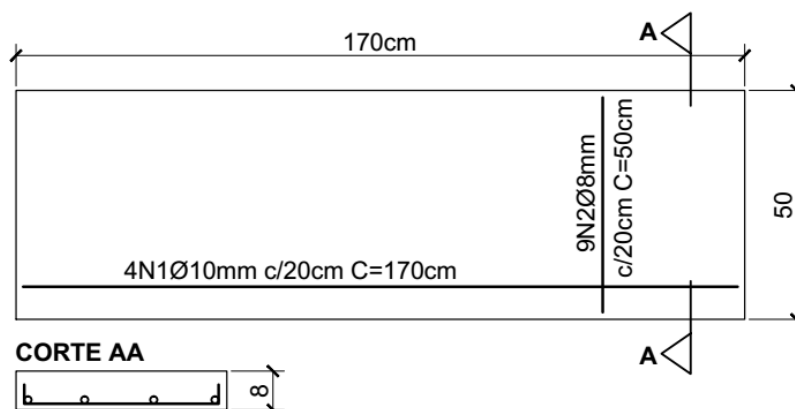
Detalhamento da armadura das lajes (IBRAHIM e ELADAWY, 2014).
